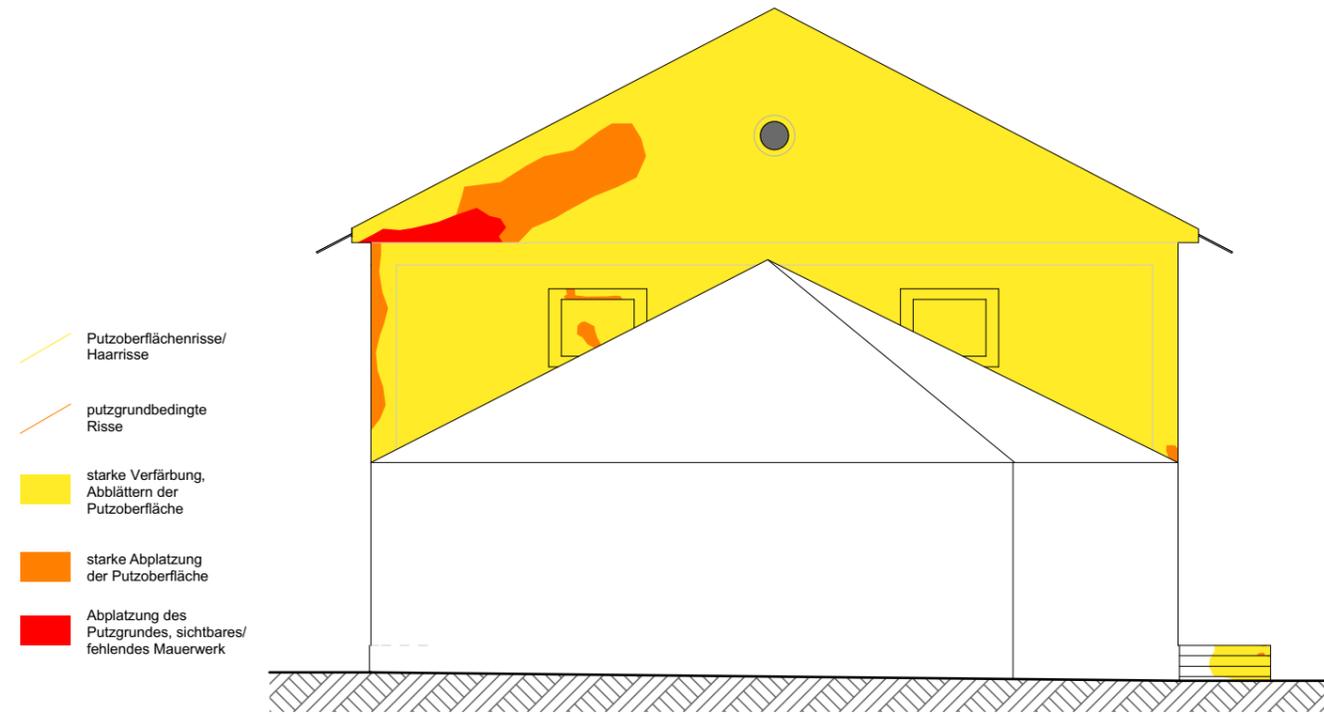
Schadenskartierung der nördlichen Fassade
